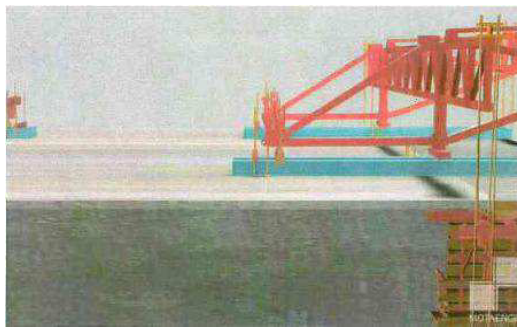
PROC Betonagem das almas e laje superior [11]
